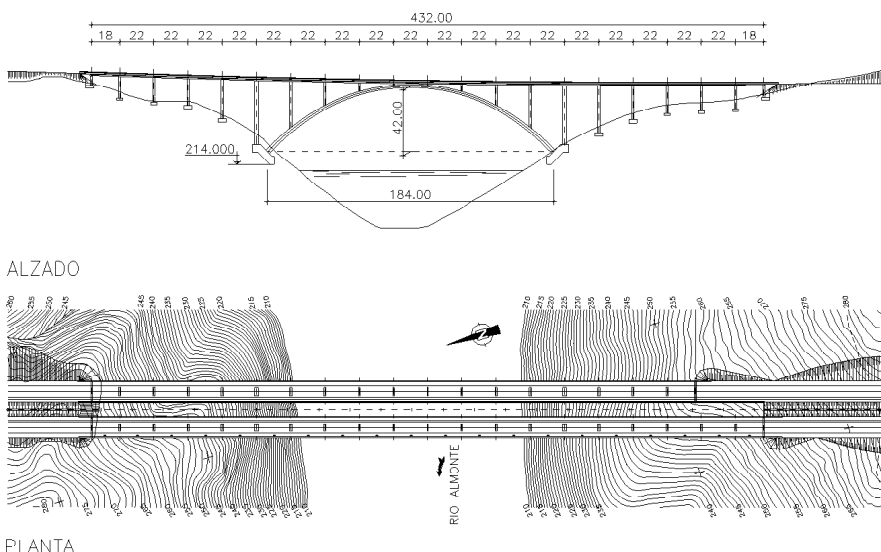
Solución Propyectada: Planta y Alzado generales.
